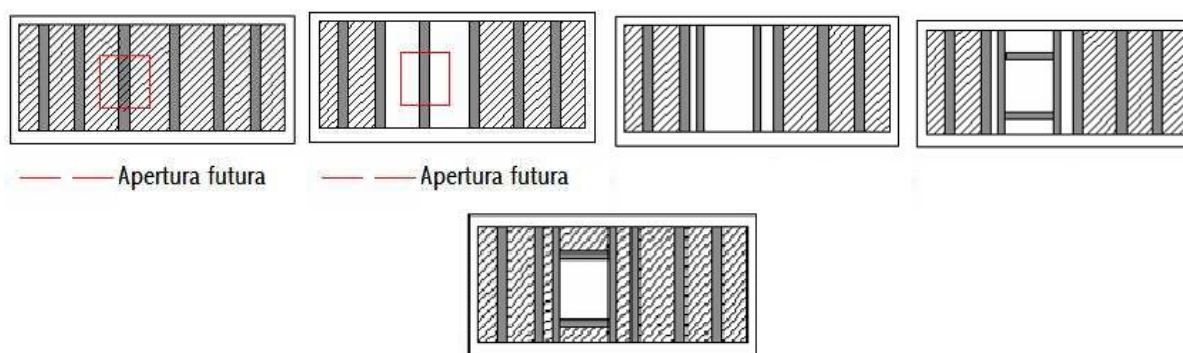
Formación de un vano mediante la construcción de vigas
